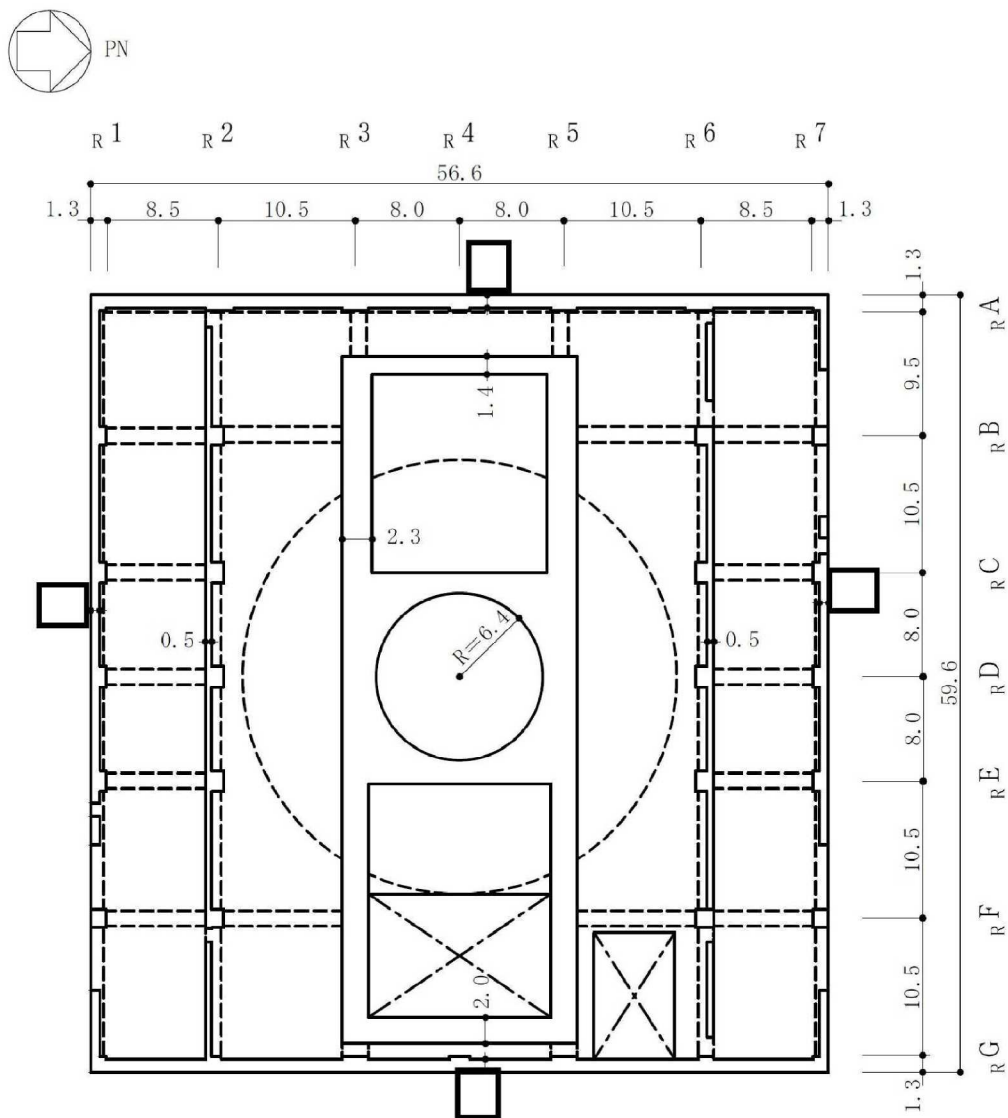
原子炉建屋の概略平面図 (2F, T.M.S.L. 18.1m) (5/9)
